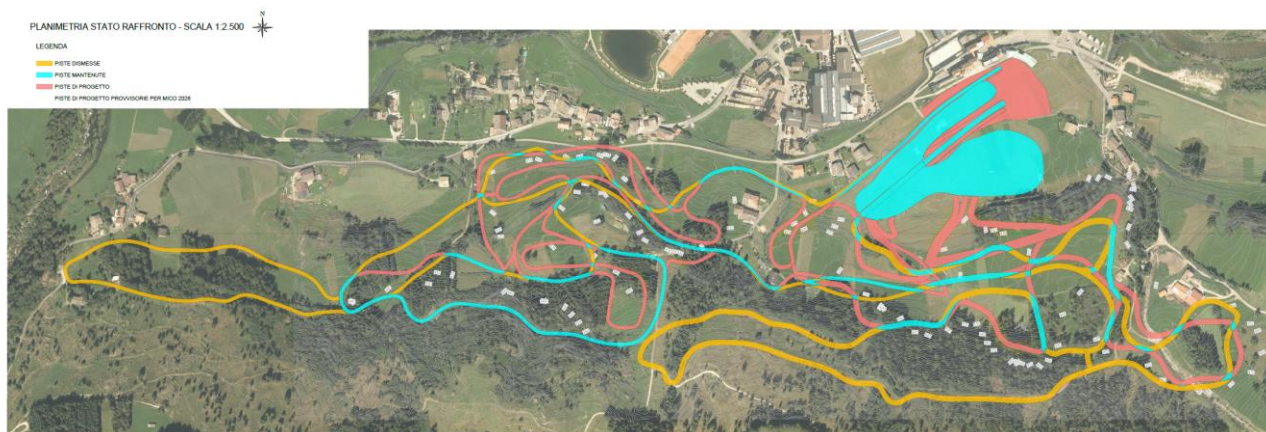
Planimetria di raffronto scala a vista (vedasi tavola D.T.311.002)
